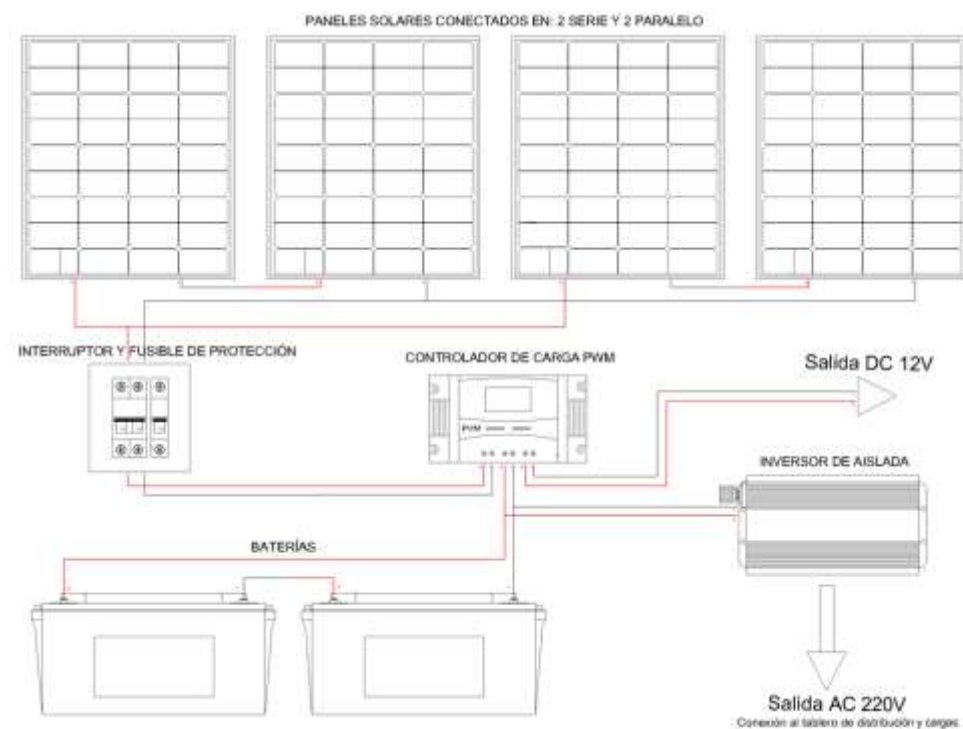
Diagrama de conexión para sistema aislado de la red con controlador PWM, conexión de baterías en serie, conexión de paneles solares (2 en serie y 2 en paralelo).
